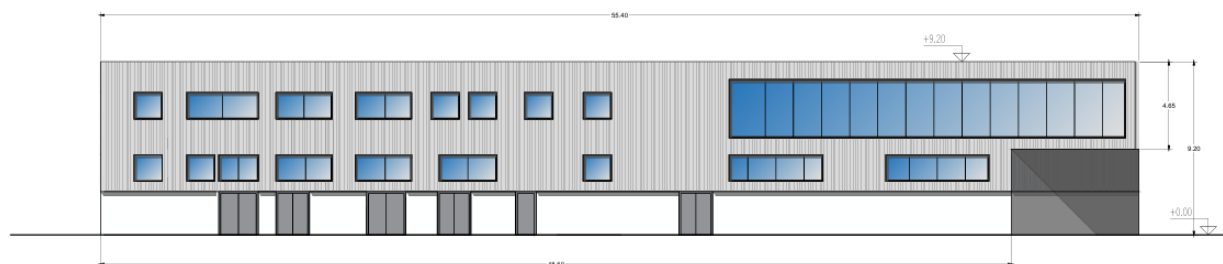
Officina manutenzione rotabili_ Prospetto Ovest
